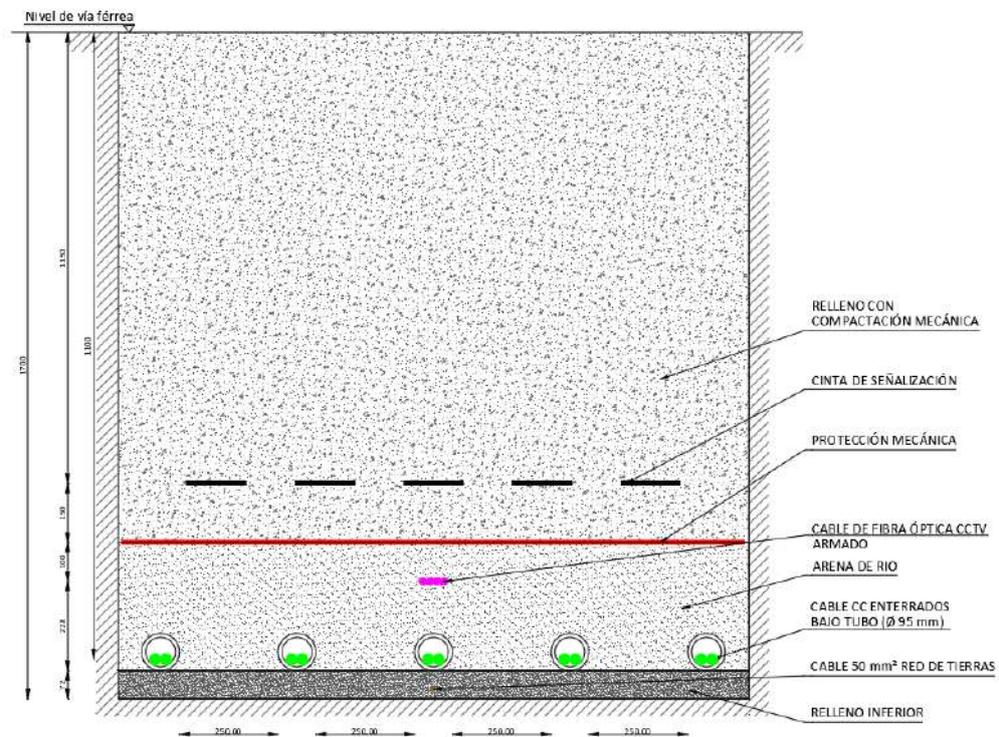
Zanja baja tensión bajo línea ferroviaria
